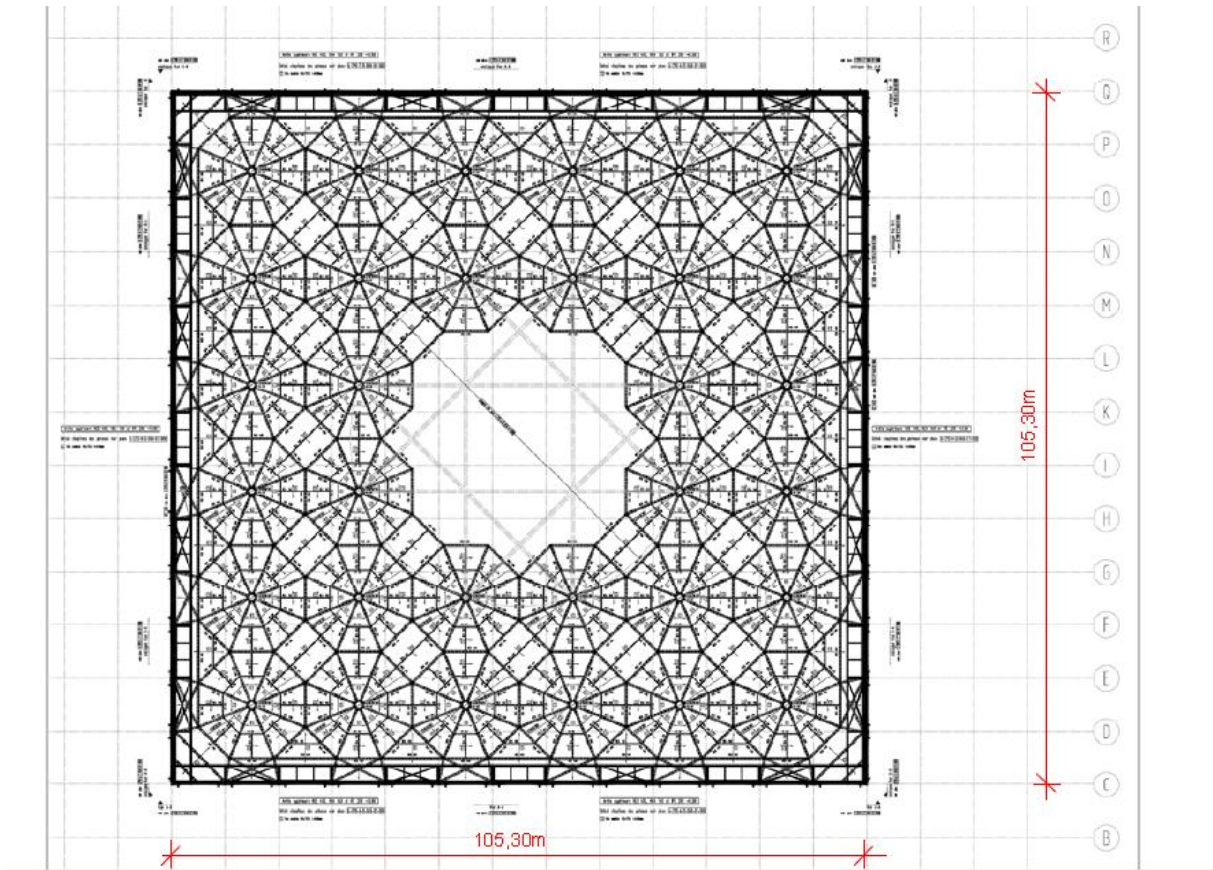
construction métallique du cube intérieure –vue en plan
